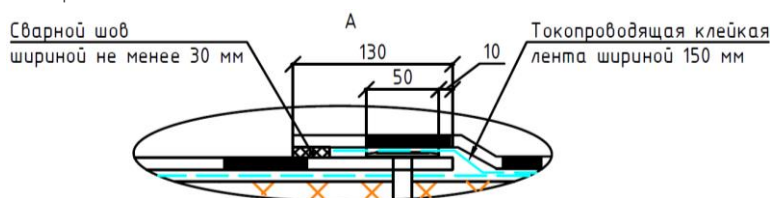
Схема устройства токопроводящей ленты в сварном шве
